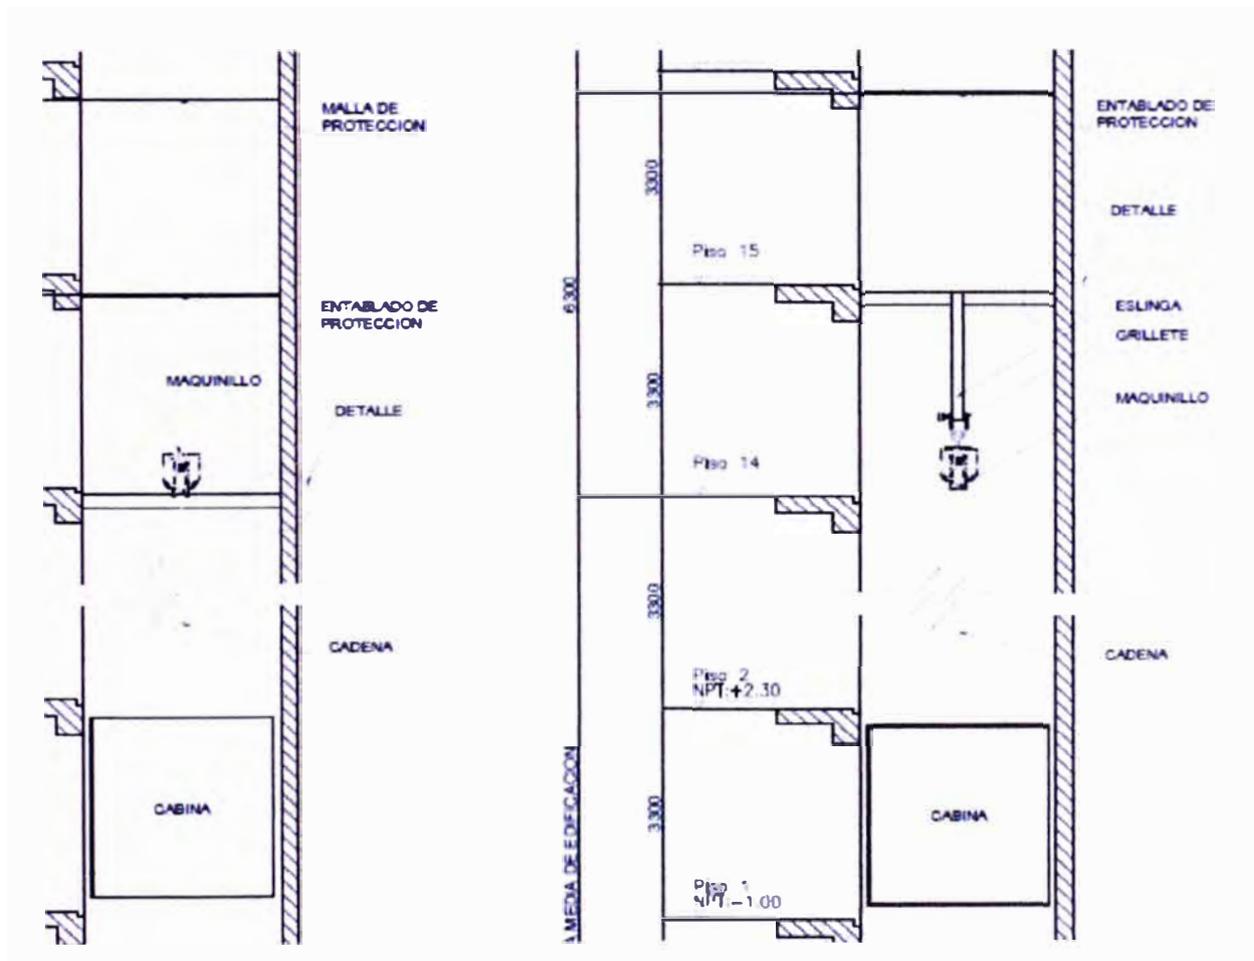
Maquinillo a media altura, junto con las vigas de soporte
